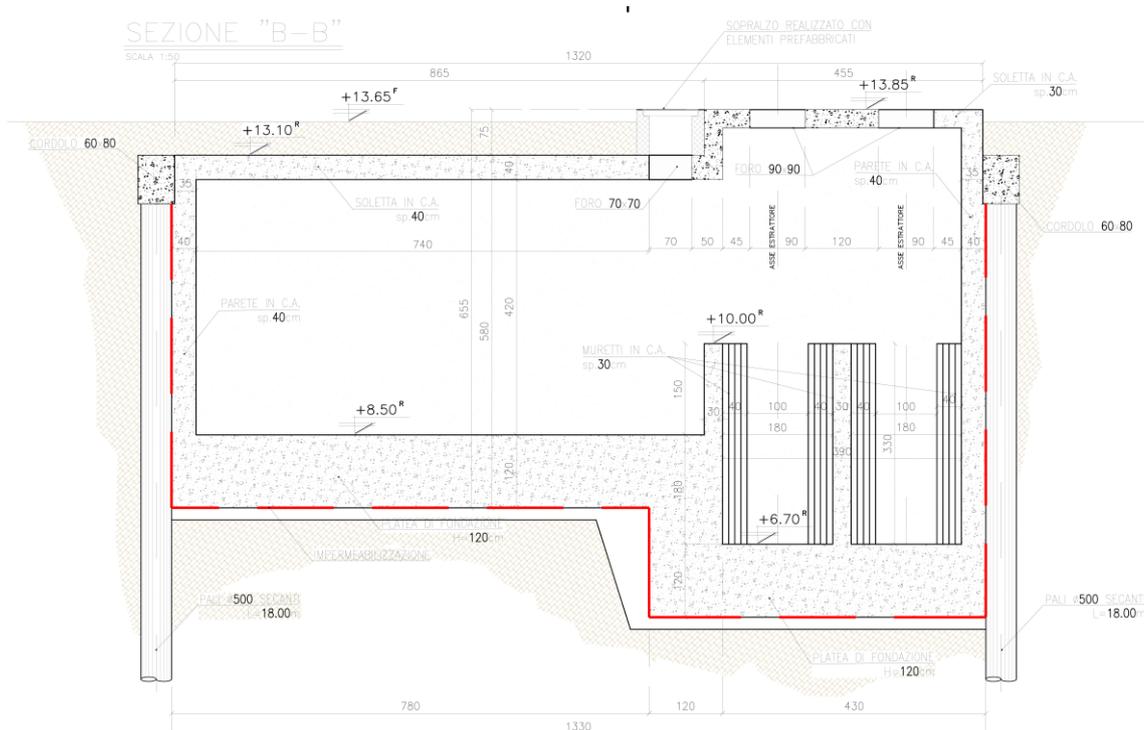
Vasca di sollevamento - Sezione longitudinale
